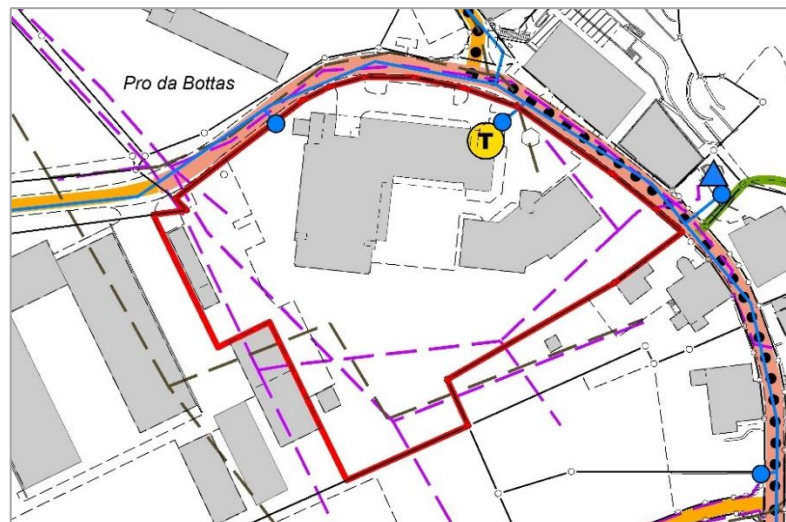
Genereller Erschliessungsplan (rechtskräftig)
